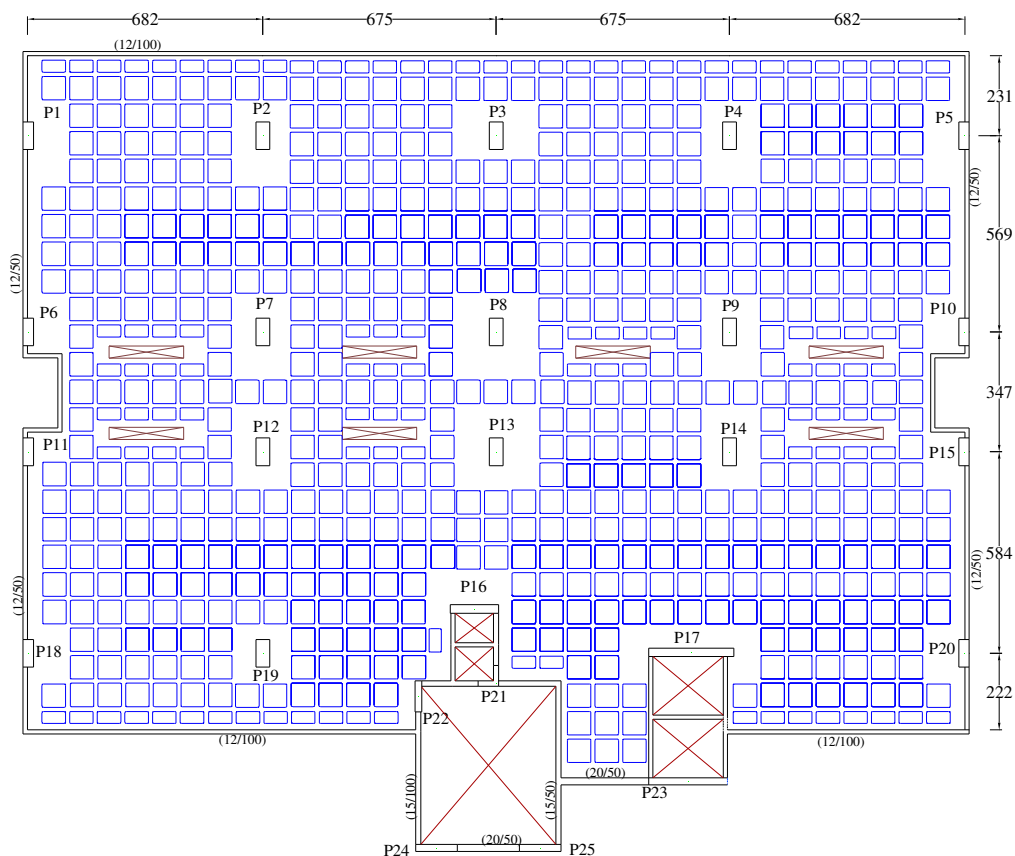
Planta baixa do pavimento tipo do primeiro exemplo
